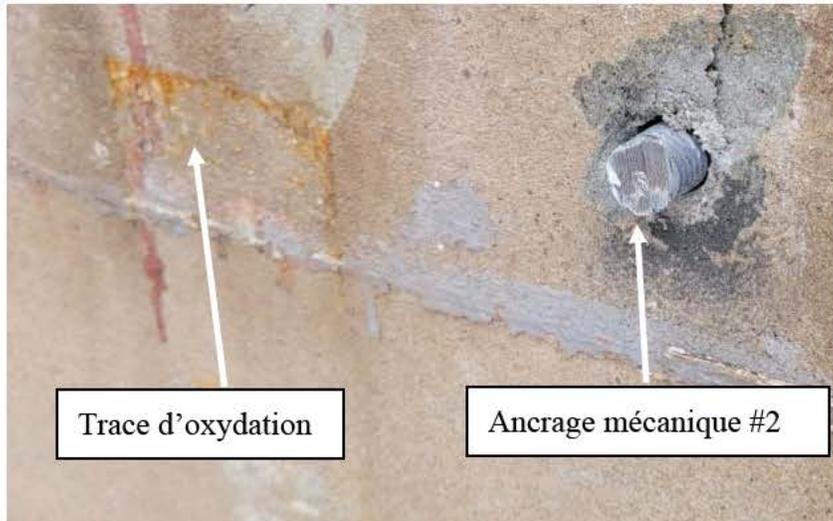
Oxydation sur la fondation du bâtiment existant
